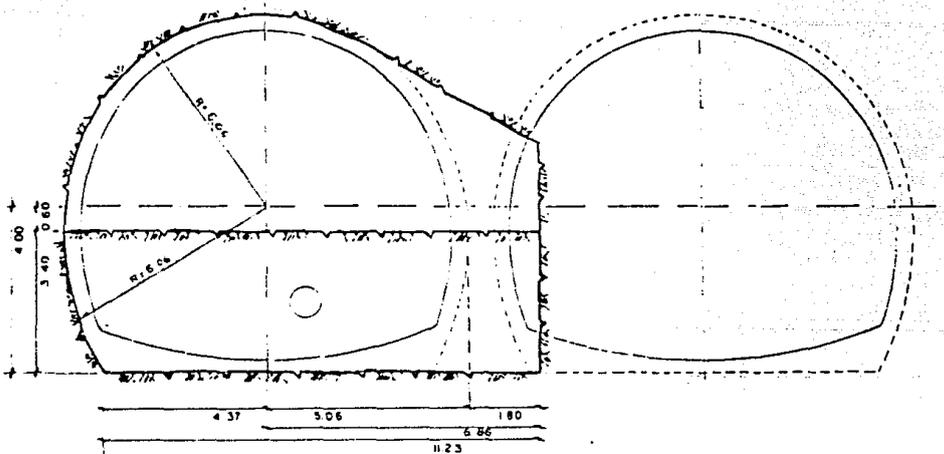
TRAMO DE TRANSICION MEDIA SECCION INFERIOR BANQUEO.
